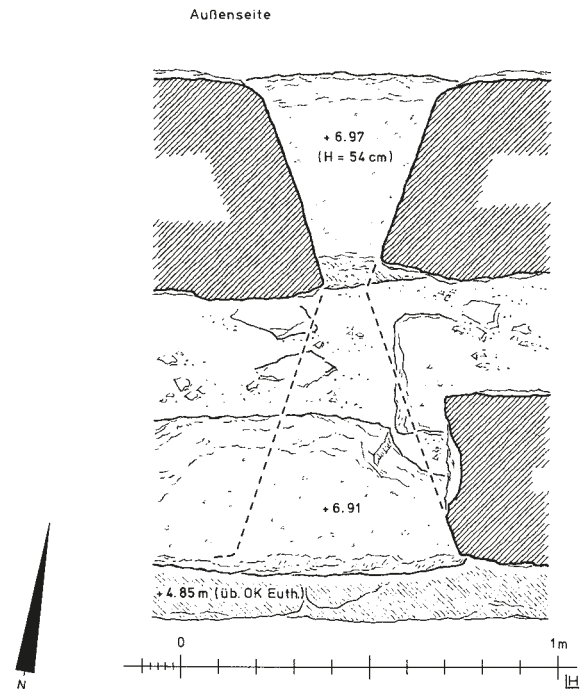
Pyrgos Plakas, Nordwand, Fensterschlitz im Grundriß (M. 1 : 20)
